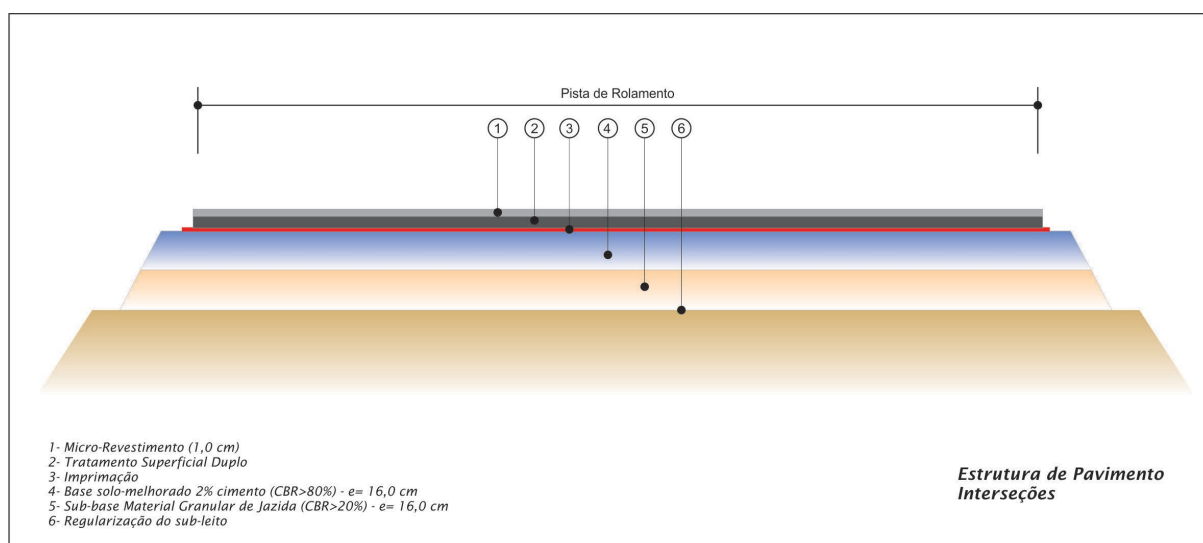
Estrutura de pavimento projetada para Interseções 01,02 e 03
